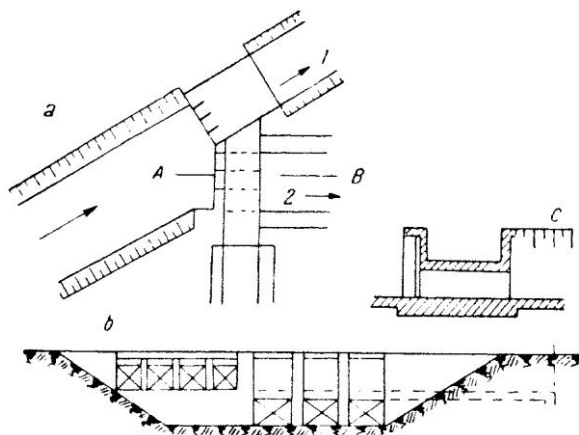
Stăvilă frontal: a – plan; b – vedere din față;
